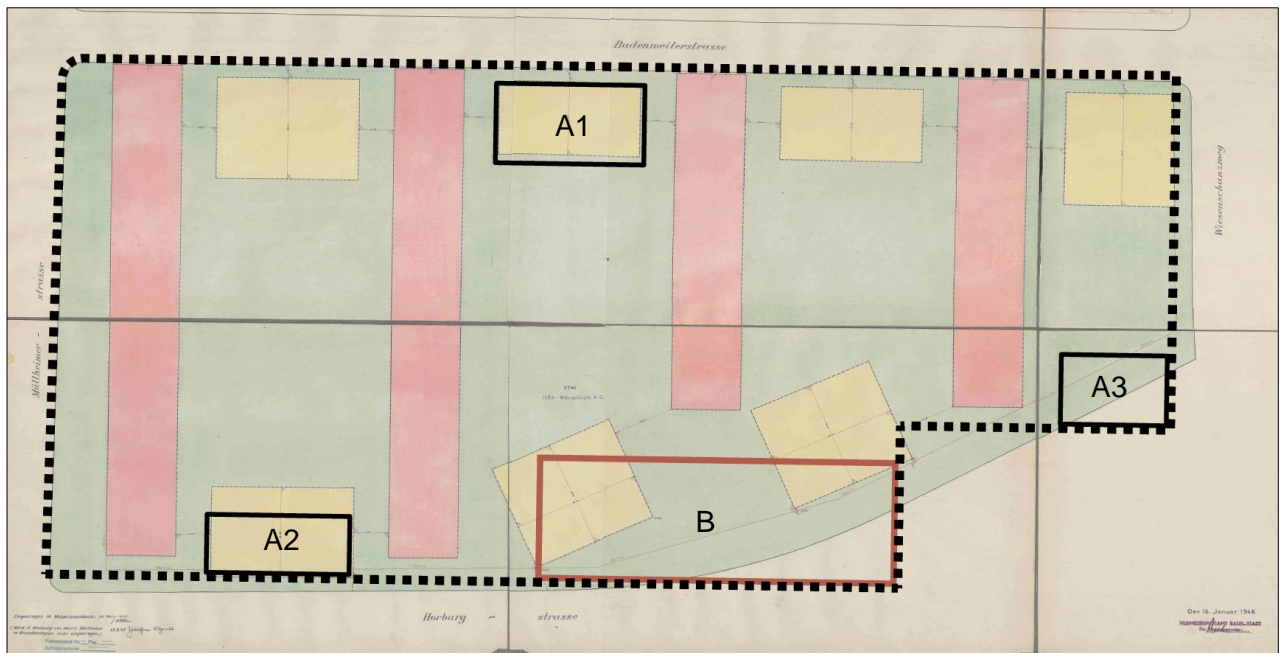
Servitutsplan Nr. 1873 überlagert mit den Baufeldern des Bebauungsplans (kein Massstab, Plan genordet)
